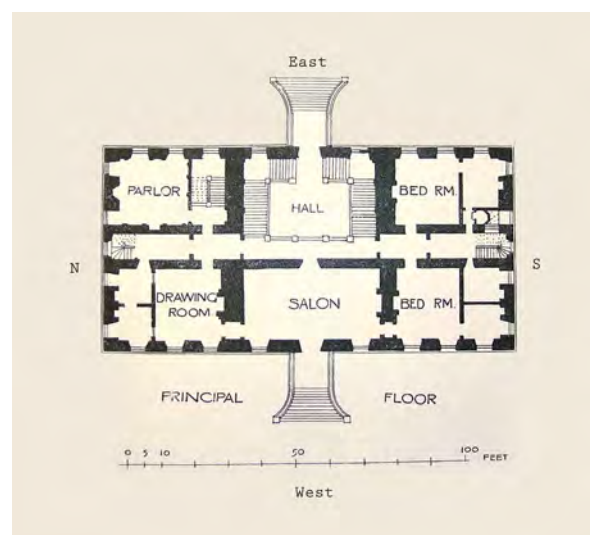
El espacio premoderno. Coleshill House, construida por sir Roger Pratt en 1660.
